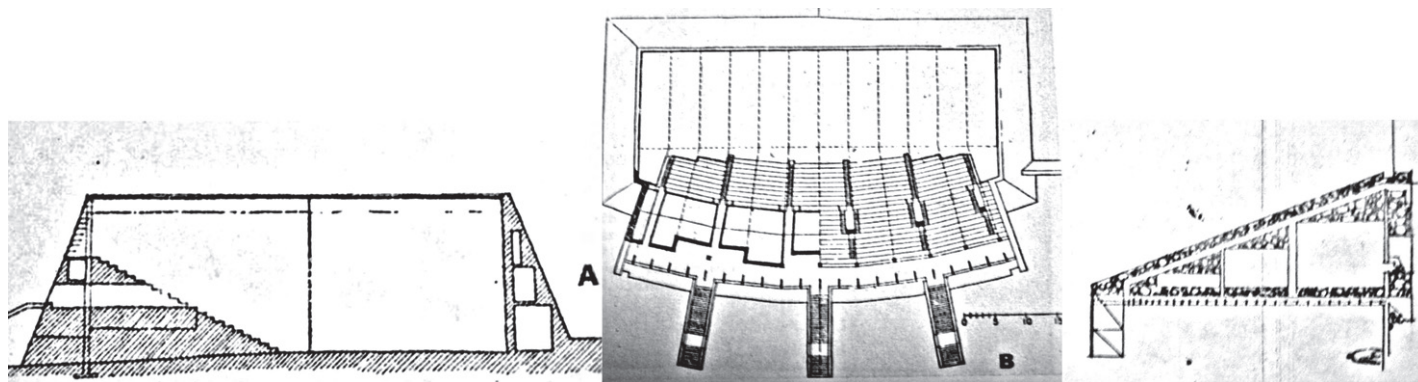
Corte y planta de chistera y detalle constructivo. Imágenes tomadas de *Les frontons, L'architecture d'Aujord'hui*, núm. 59, 1955.
